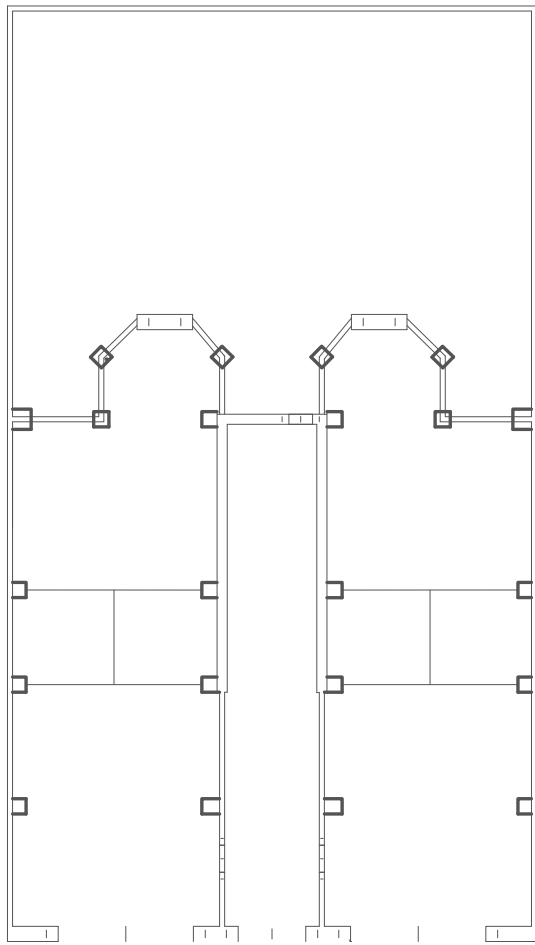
Vista en planta de PLANTA BAJA del edificio ED-02 (fuente: elaborado por el autor)
